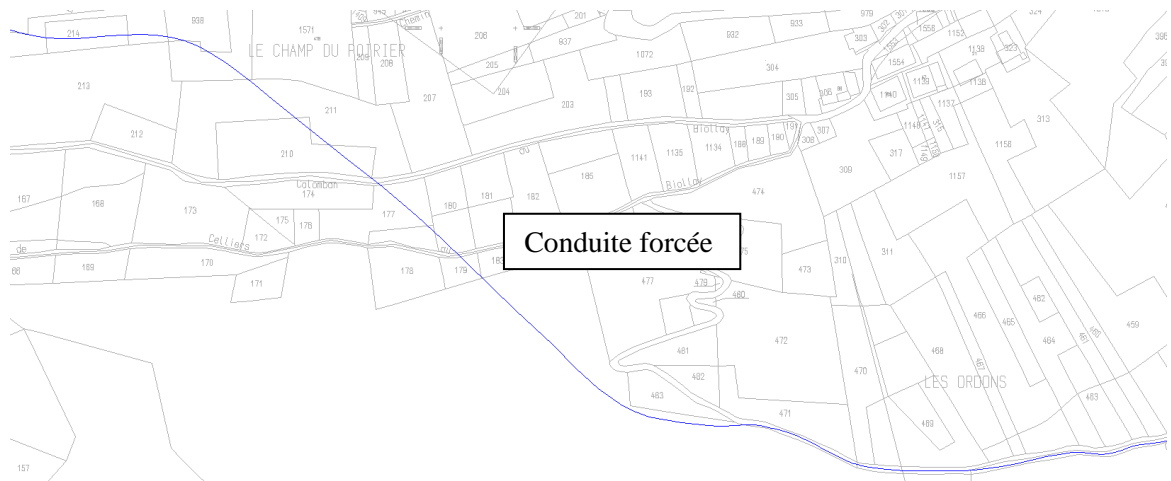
Implantation conduite forcée sur fond cadastral (4)
